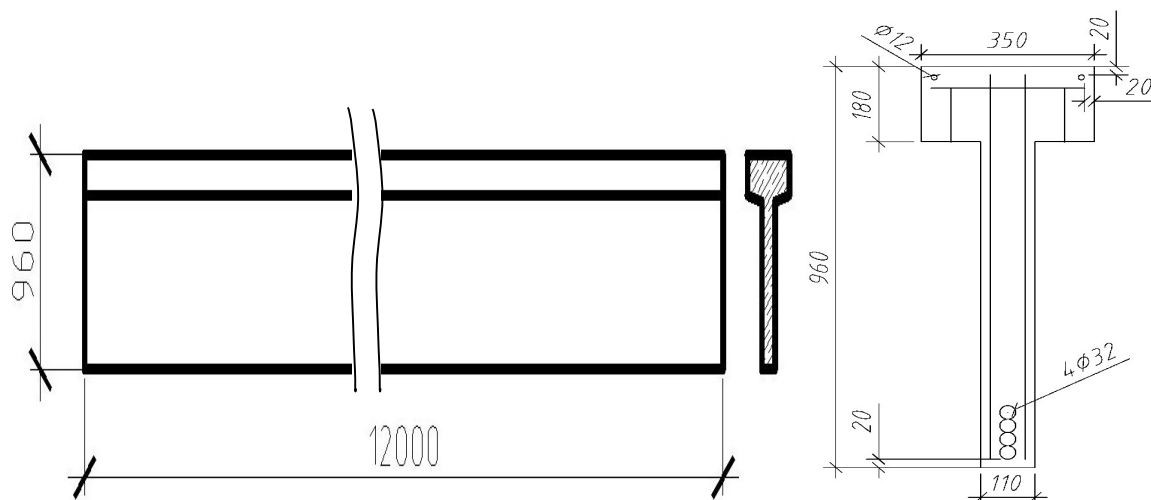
Залізобетонна балка покриття L = 12м в прольоті «А-Б». Переріз балки.
